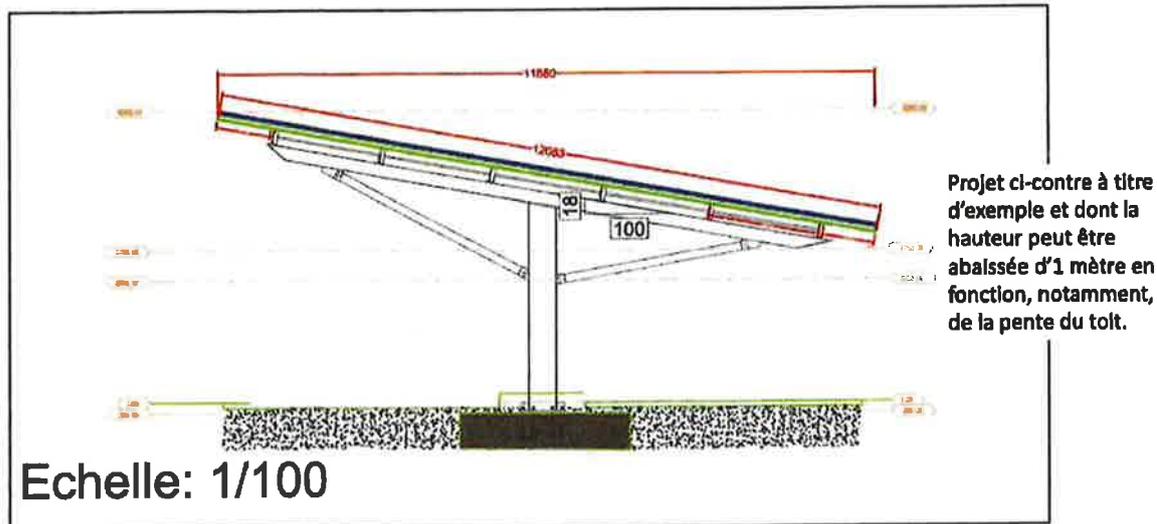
Zone 2 - vue en coupe de l'ombrière. Intervalle d'environ 10 mètres entre chaque poteau + gouttière
